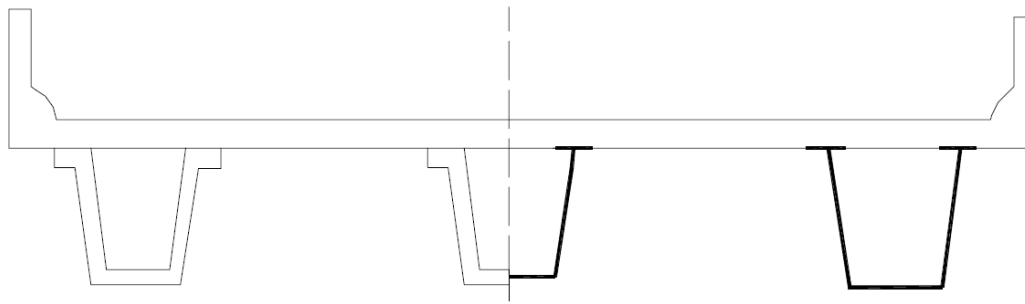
Sección transversal de puente con vigas cajón abiertas de acero o concreto reforzado prefabricado (AASHTO, 2007).
